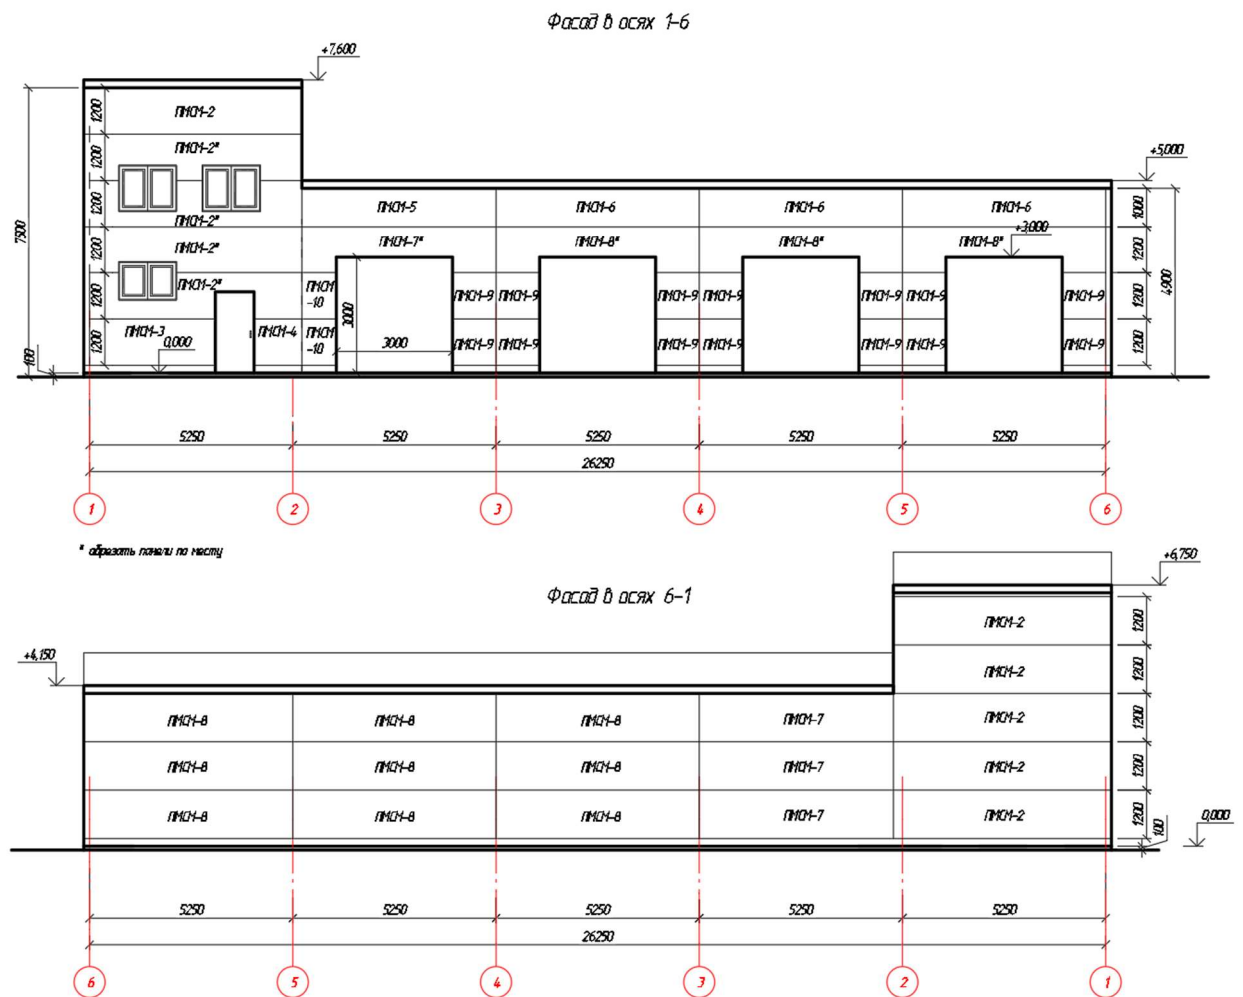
Схема раскладки сэндвич-панелей по фасадам 1-6/6-1
